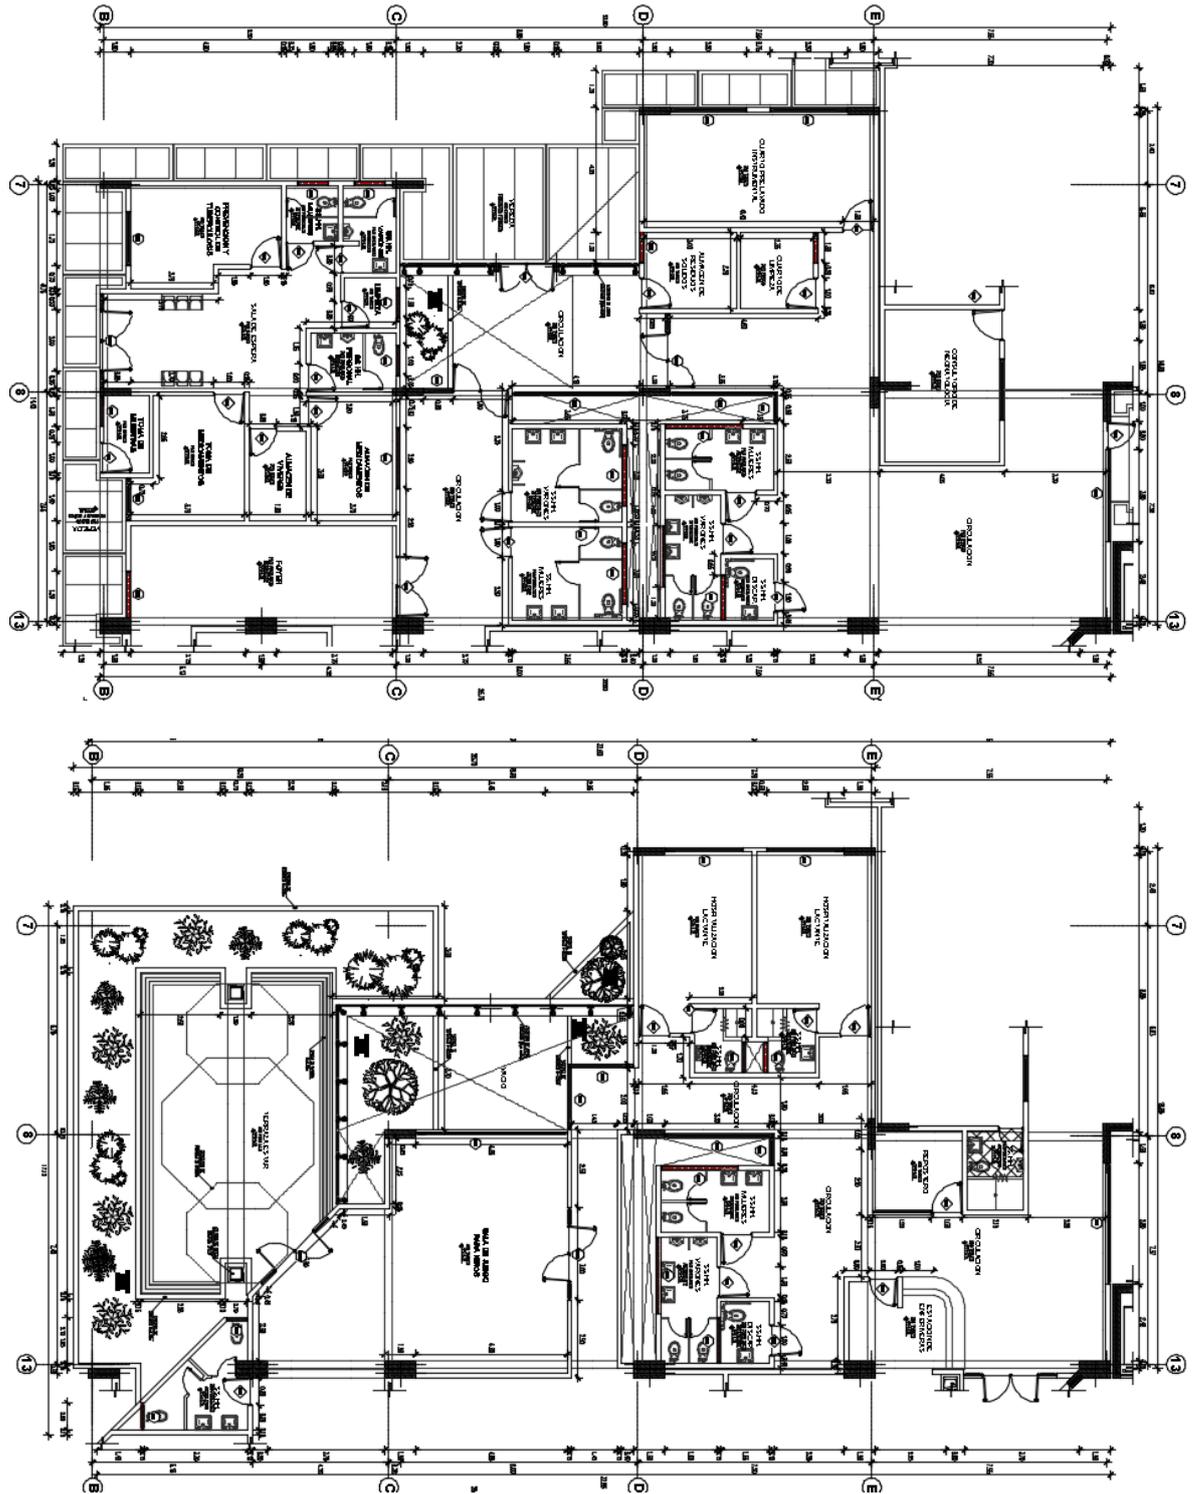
Propuesta Arquitectónica Bloque D, 1°, 2°, 3°, Techos
